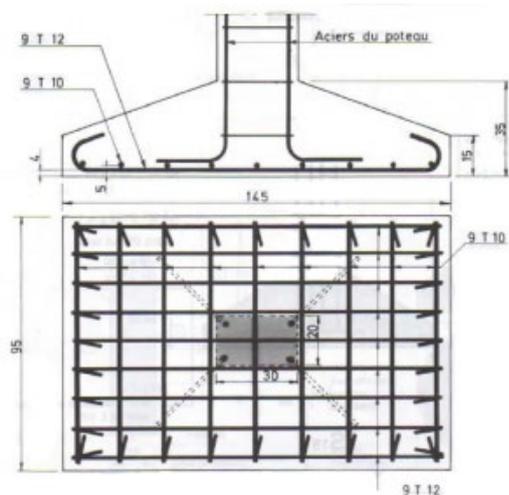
Ferrailage de la semelle isolée ¹²⁴
